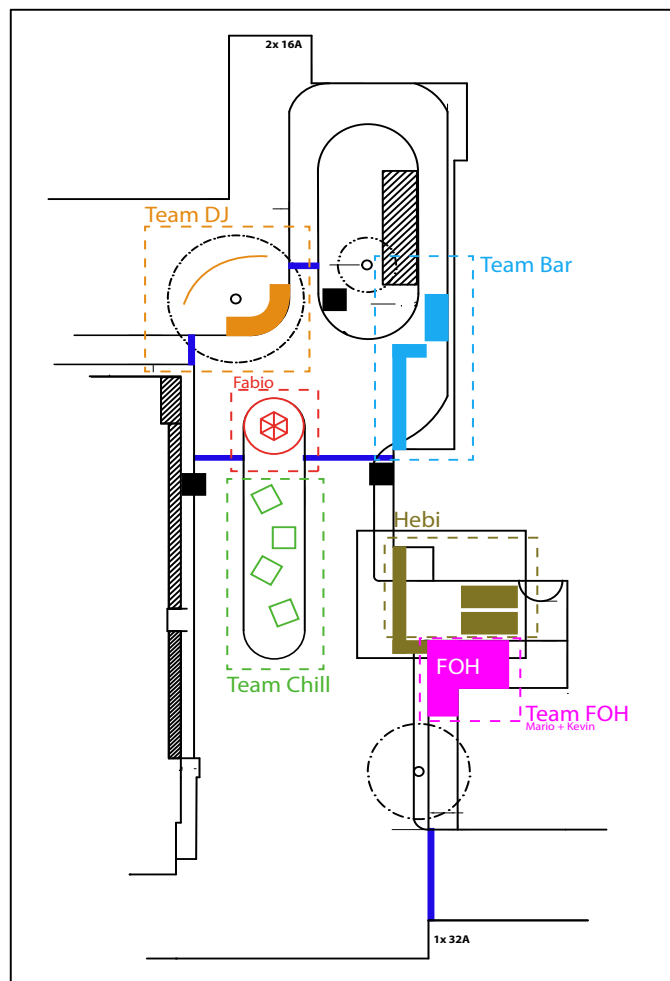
Grundriss des Innenhofs mit Veranstaltungsaufbau
